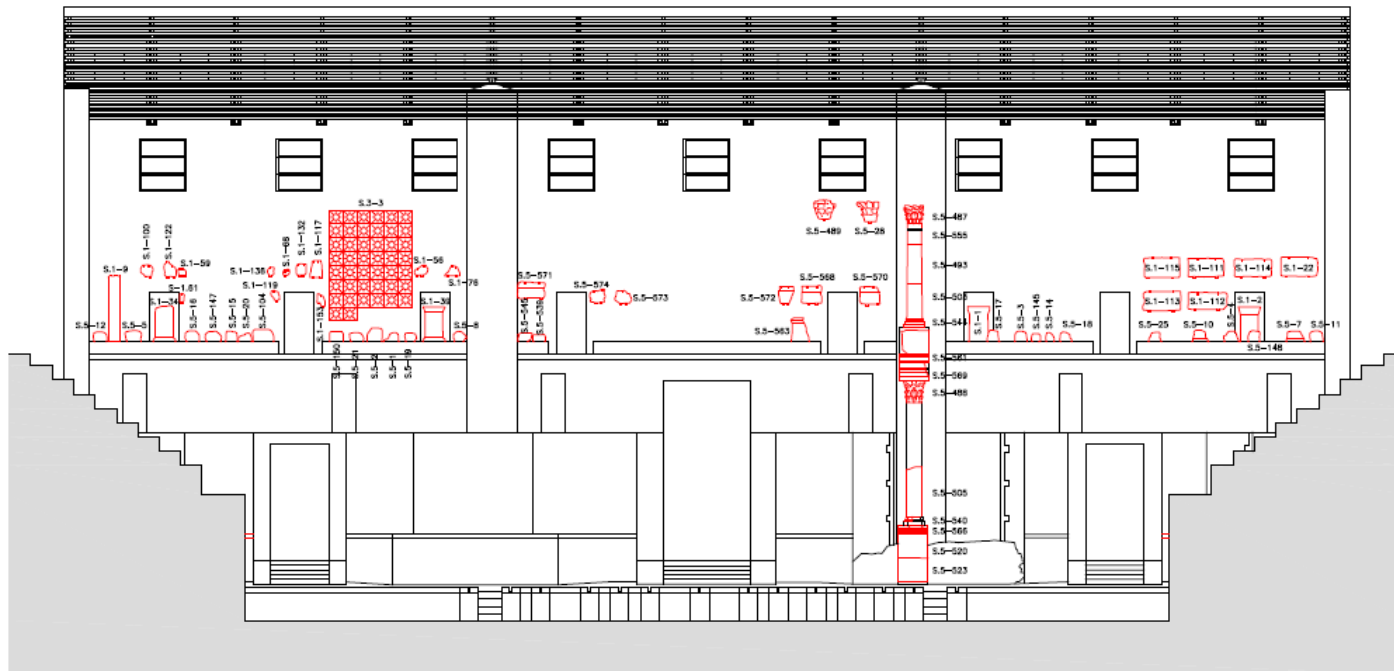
Alzado sur de la escena. Plano de intervención con anticuario.
